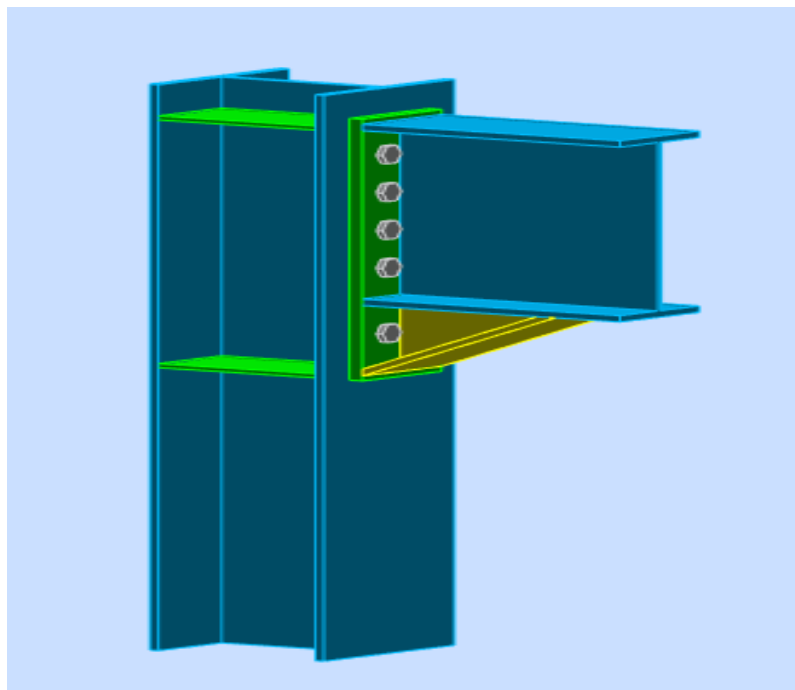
6 : Vue de l'assemblage poteau – poutre.
